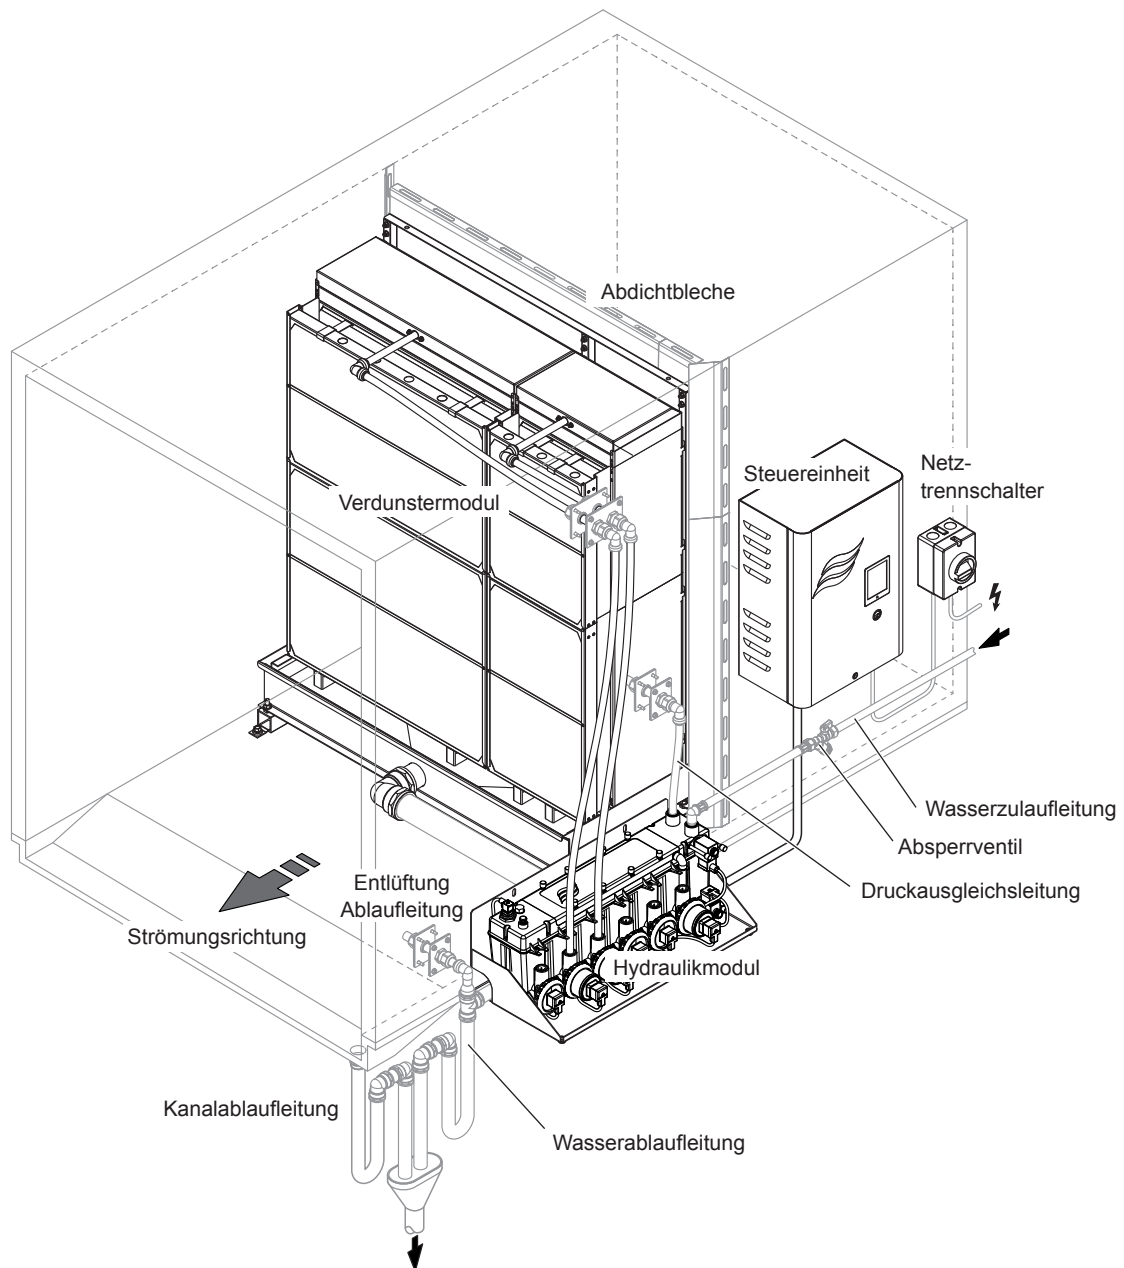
Typisches Condair ME Control System (Aussenmontage)
